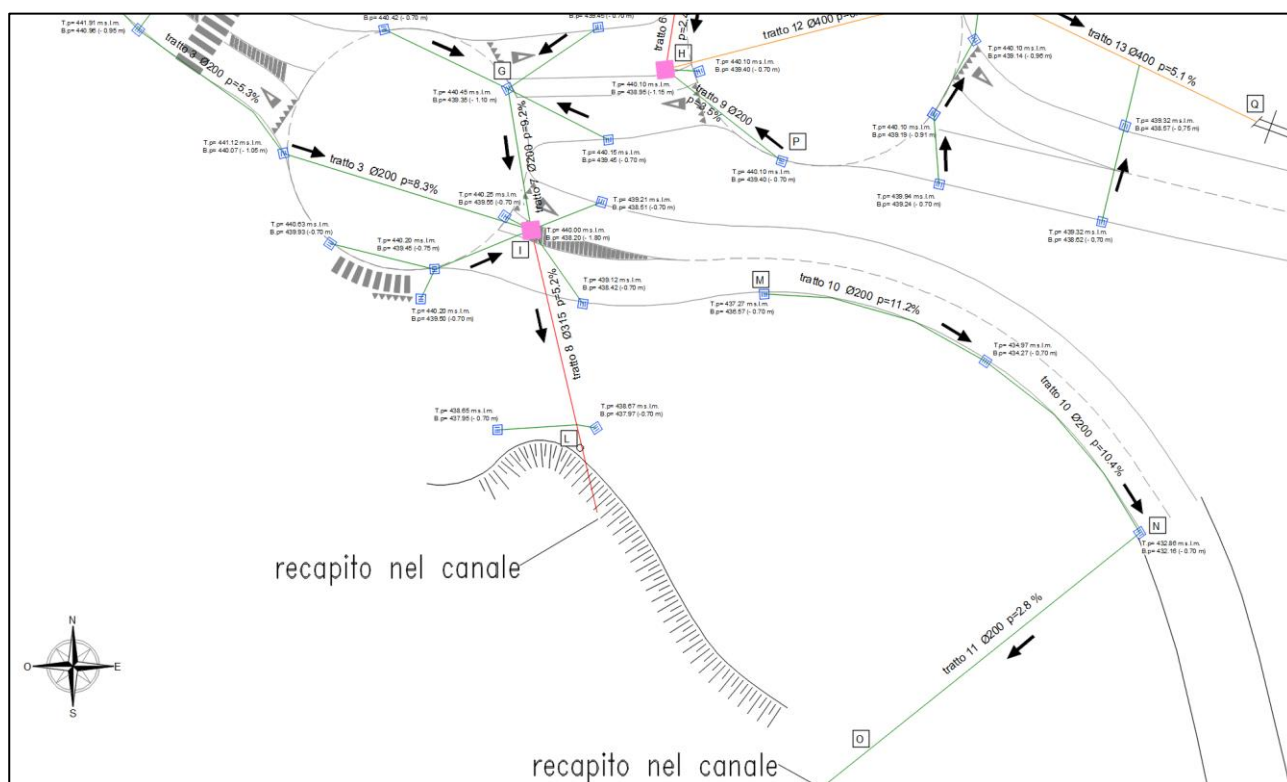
Estratti della Tavola n.11 - Planimetria raccolta acque
